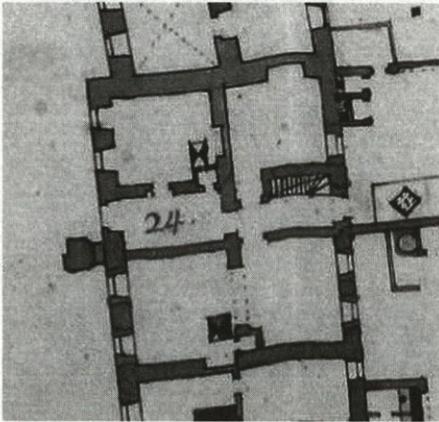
Obermünsterplatz 10, Grundriss vor 1766 (Münchner Plan).
